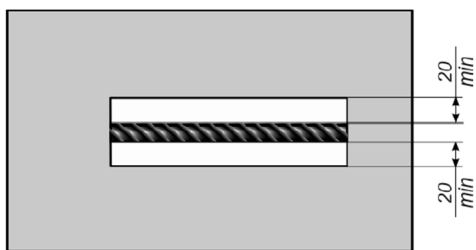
Схема нарезки штраб вдоль арматуры
